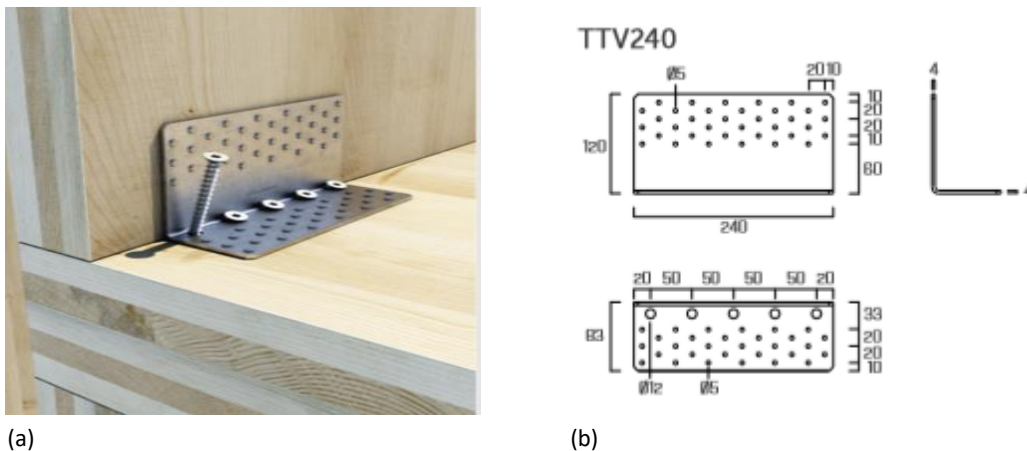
Brackets Titan V: (a) conexión madera a madera (b) detalle del Brackets.
